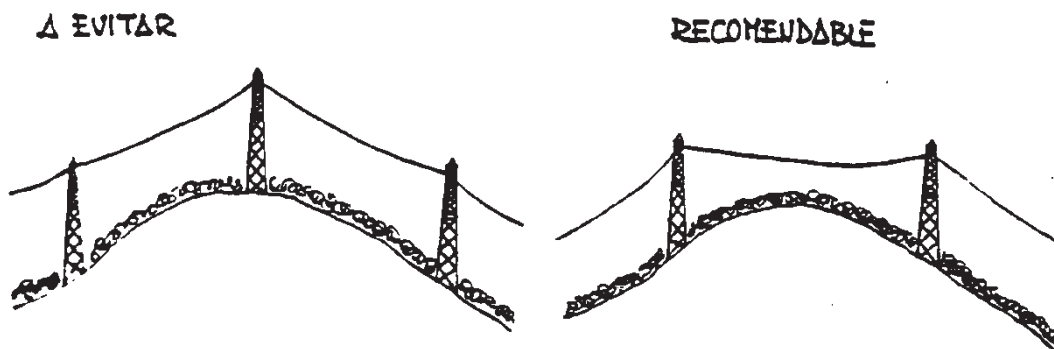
Disposición de torres eléctricas evitando las zonas elevadas. Fuente: Red Eléctrica Española (2008)
